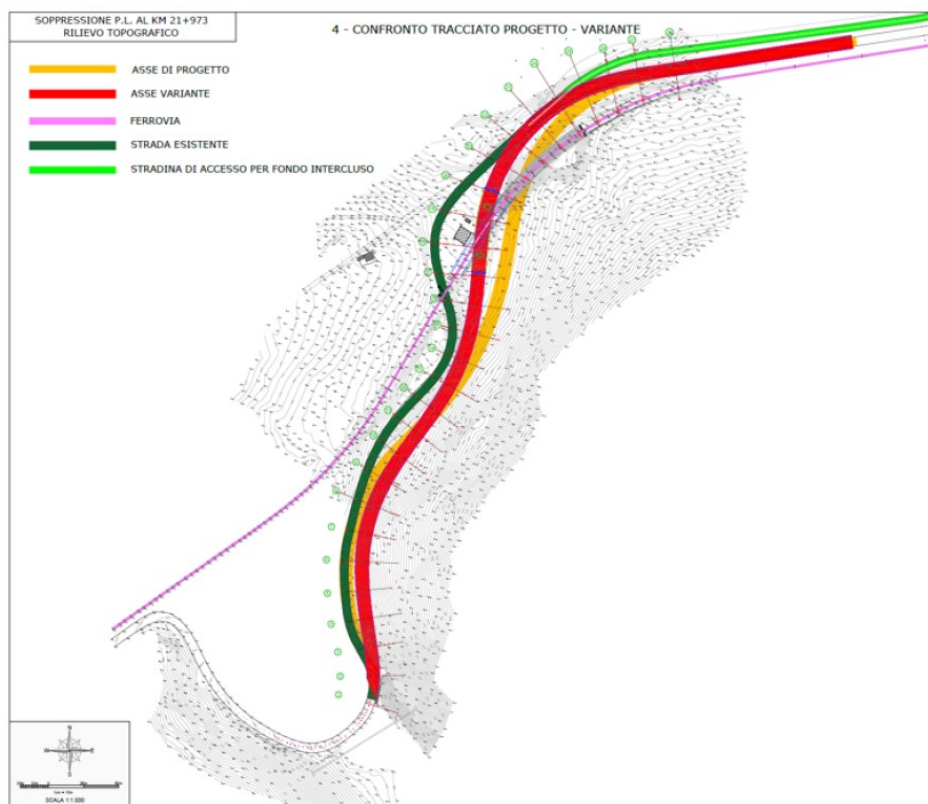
Confronto planimetrico tra la soluzione del progetto definitivo (giallo) e la variante proposta (rosso)
